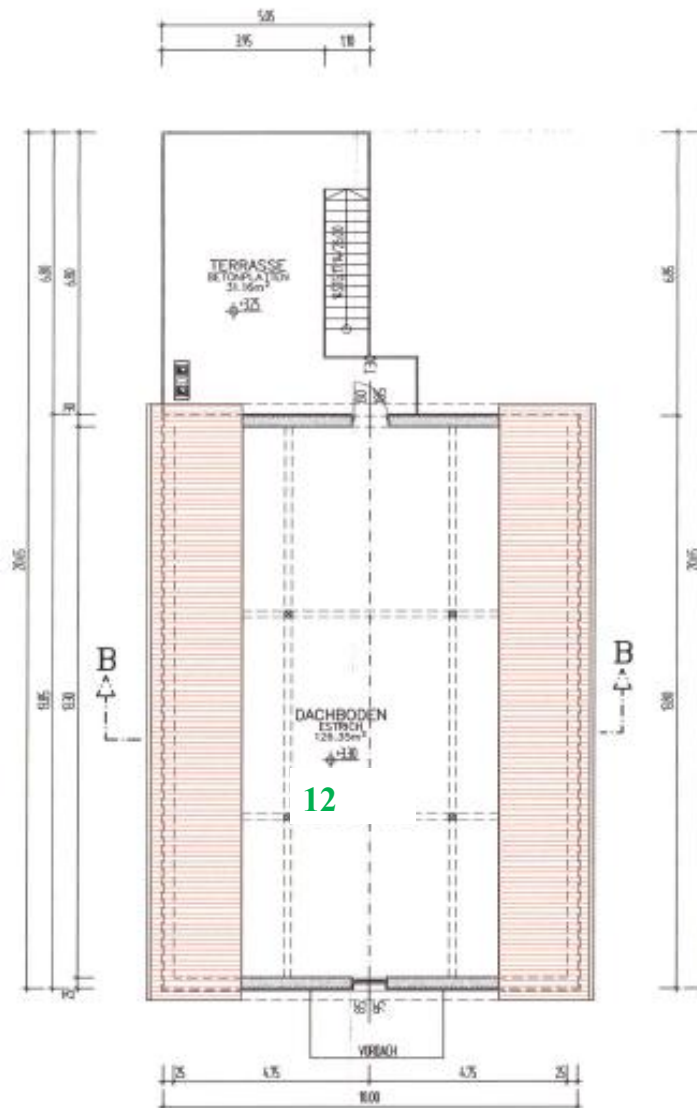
Grundrissplan Dachboden; Quelle: Bauakt (Bestandsplan 1999)
